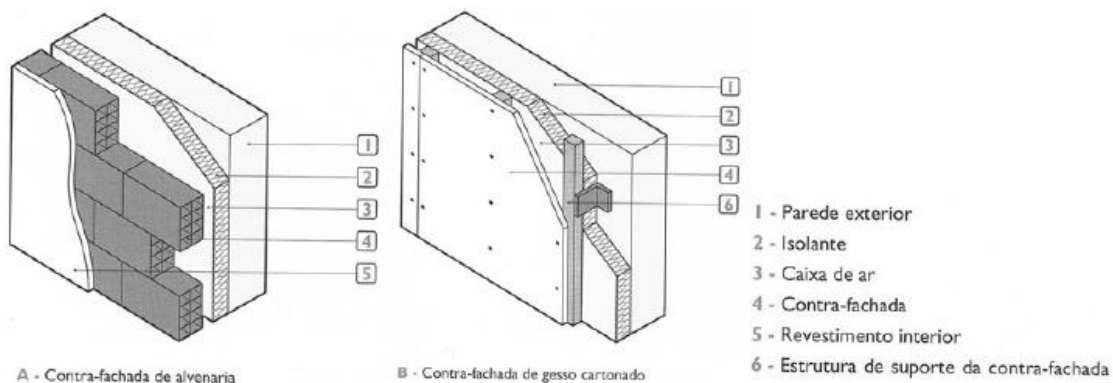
Sistema de contra fachada, a) – Contra fachada de alvenaria, b)- contra fachada em gesso cartonado [4]
